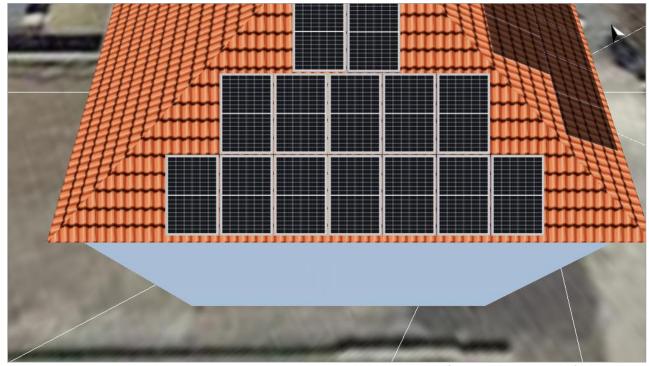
Modulfläche - Gebäude 01-Dachfläche Südwest
